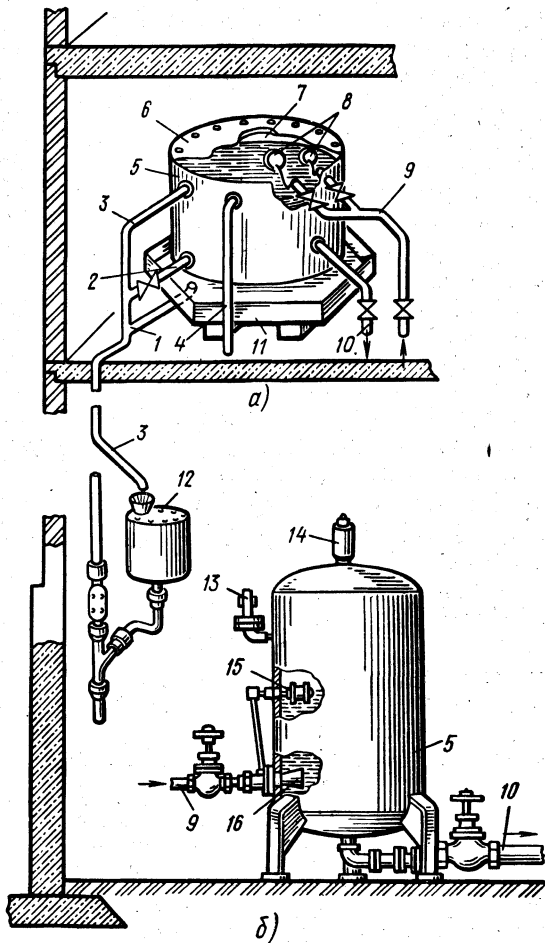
Водонапорный (а) и гидропневматический (б) баки:
